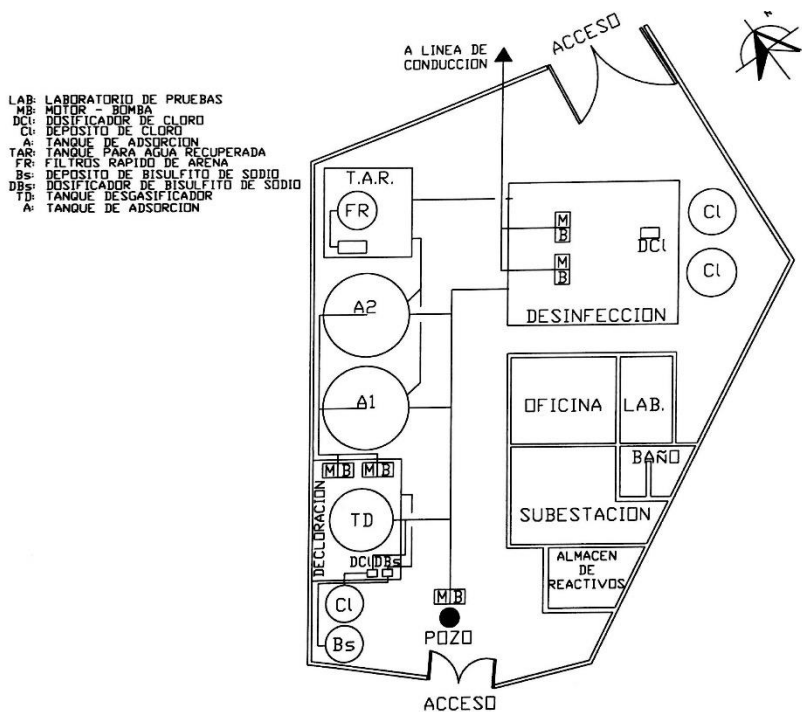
Vista en planta de la PP Purísima Cerrillos 2
